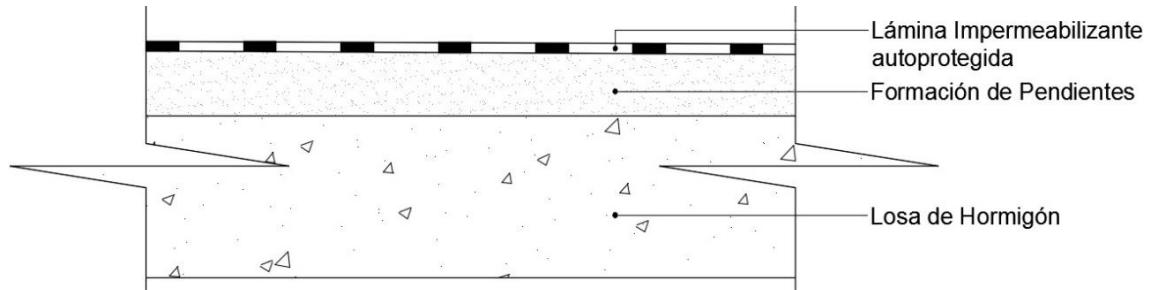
Sección constructiva del cerramiento de la cubierta del casetón
